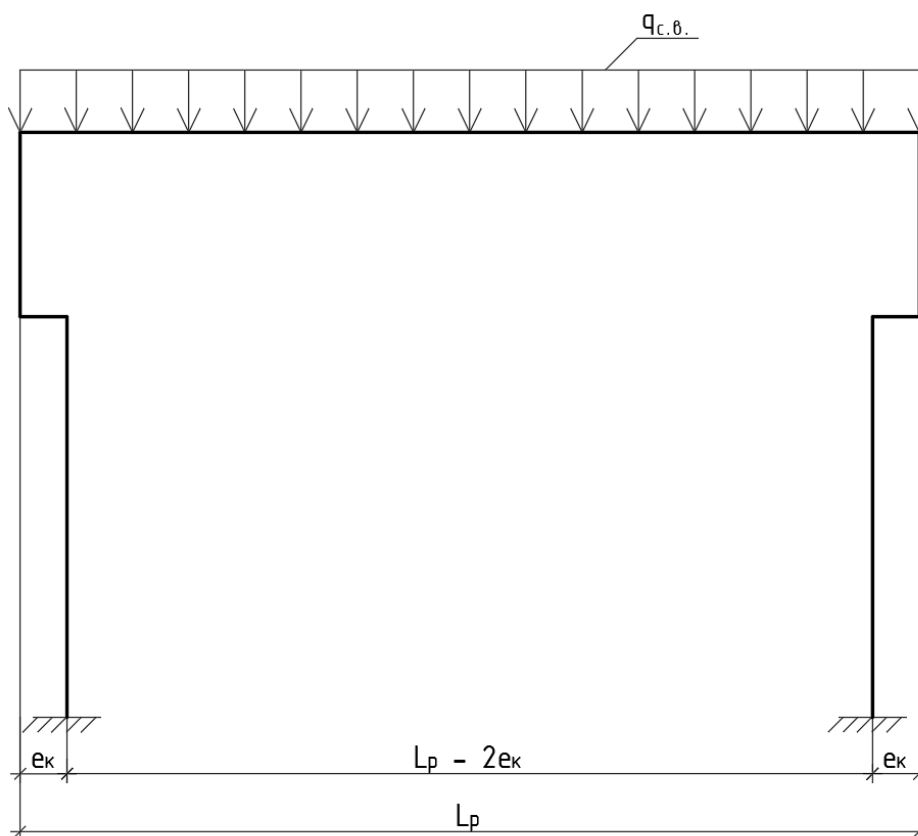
Схема действия нагрузки от собственного веса покрытия
